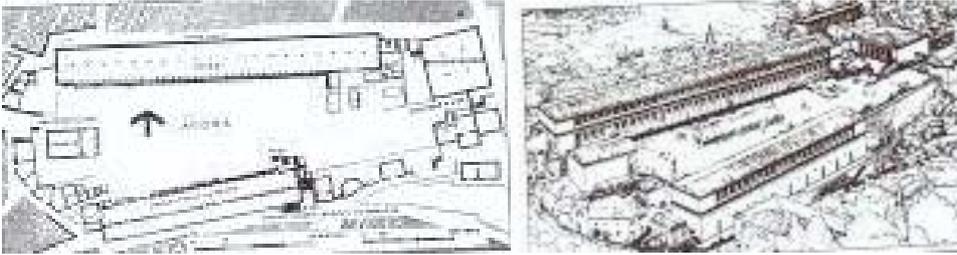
Assos; plano reconstruido del Ágora, y una vista hipotética en perspectiva.
